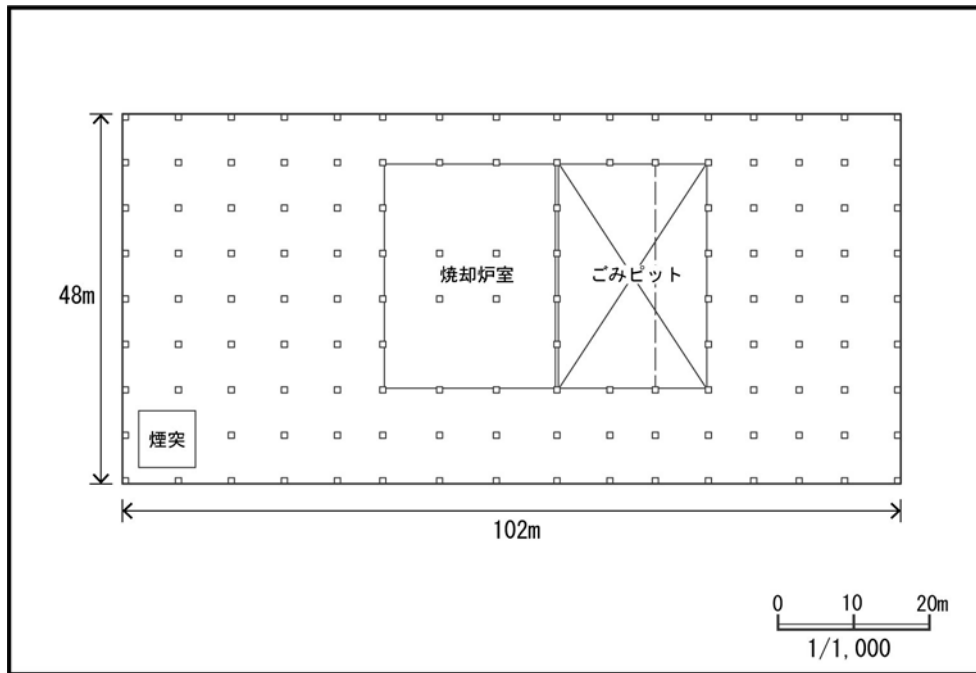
(1) 新施設の平面図（新焼却処理施設地下 1 階）
